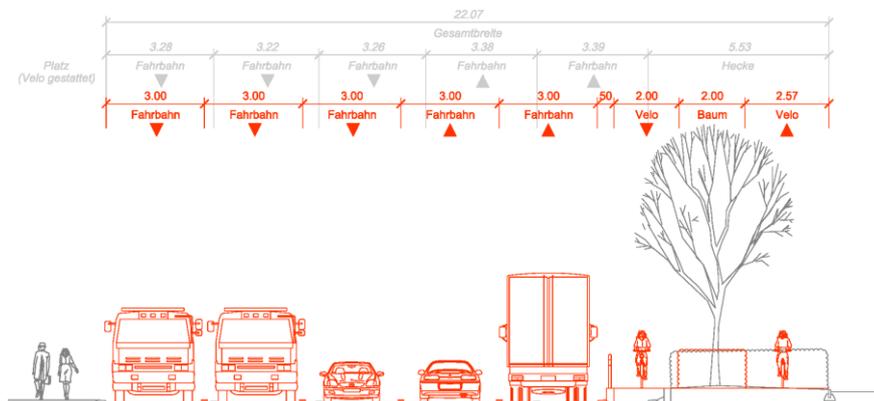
Querschnitt Utoquai (Abschnitt Bellevue bis Falkenstrasse) mit angepassten Fahrstreifenbreiten, Querschnitt mit bestehenden Baum (Blickrichtung Süd)
